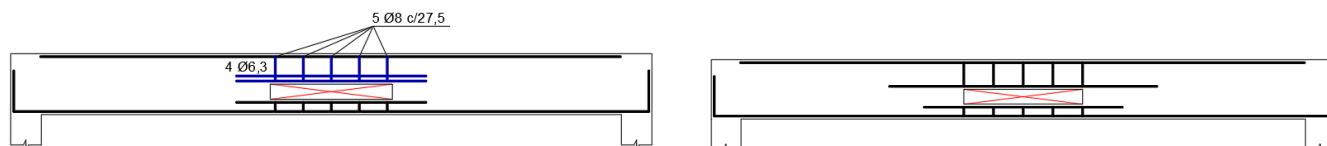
Detalhamento por bielas e tirantes e por flexão composta reta da viga 3.
